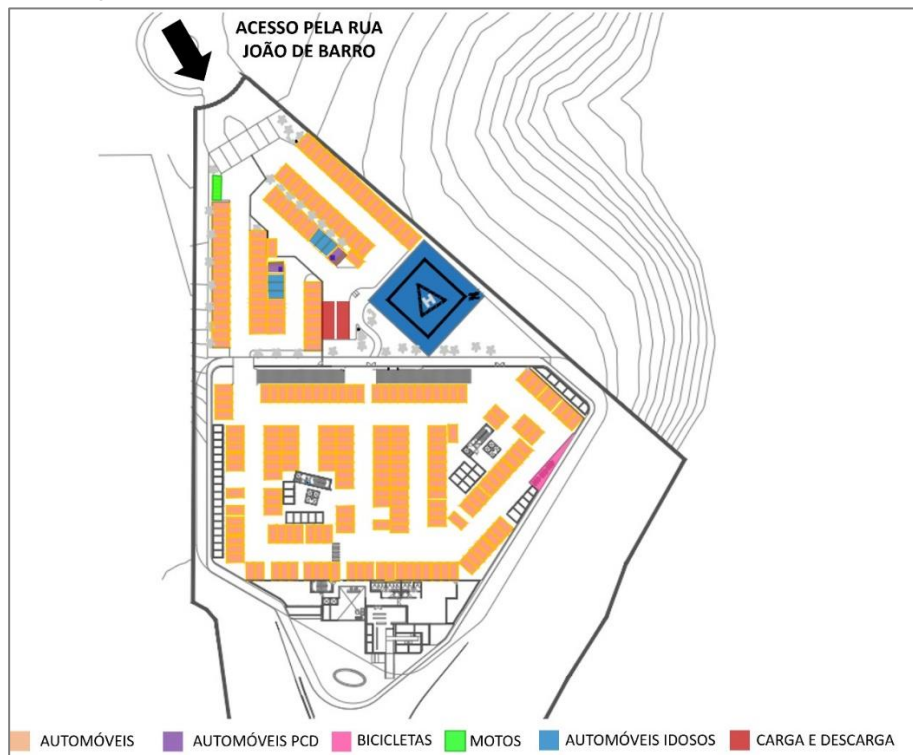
Planta esquemática do pavimento Estacionamento 2.
